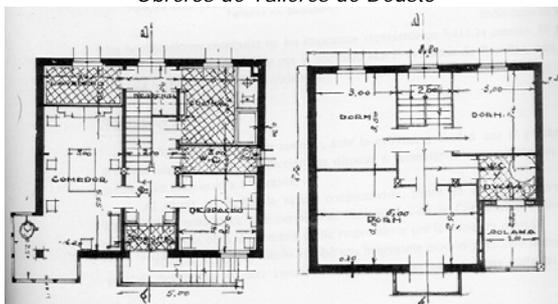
Planta baja y piso superior de las viviendas de Obreros de Talleres de Deusto
